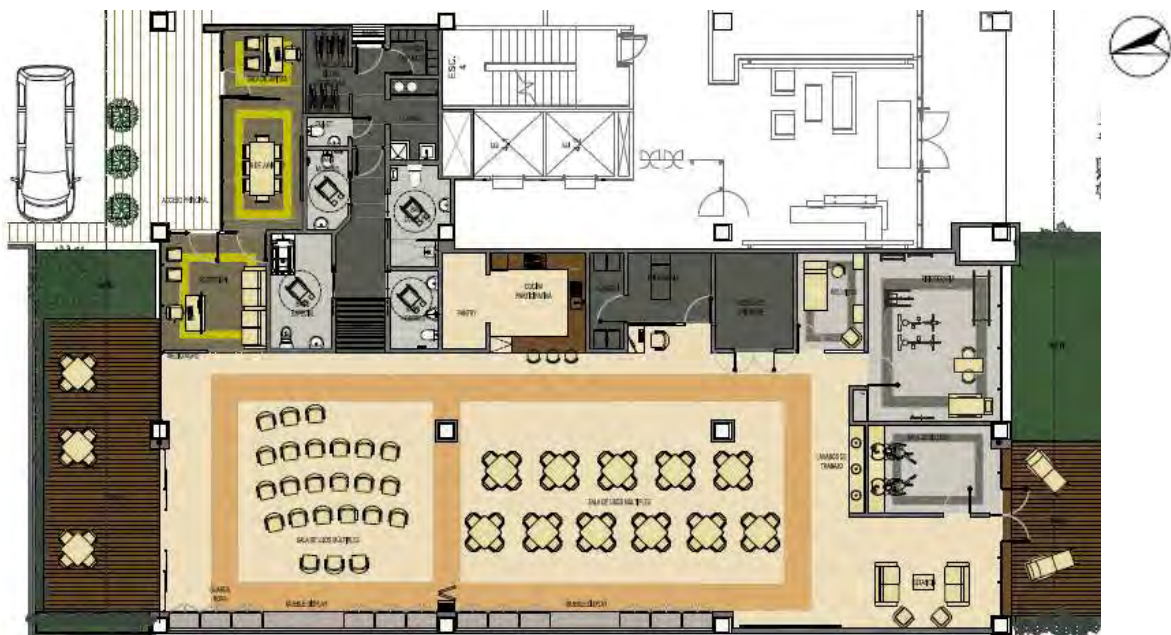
Plano arquitectónico sin escala de Meridia en la de apertura. Abril de 2013. Plano sin escala. (Meridia, 2015).
